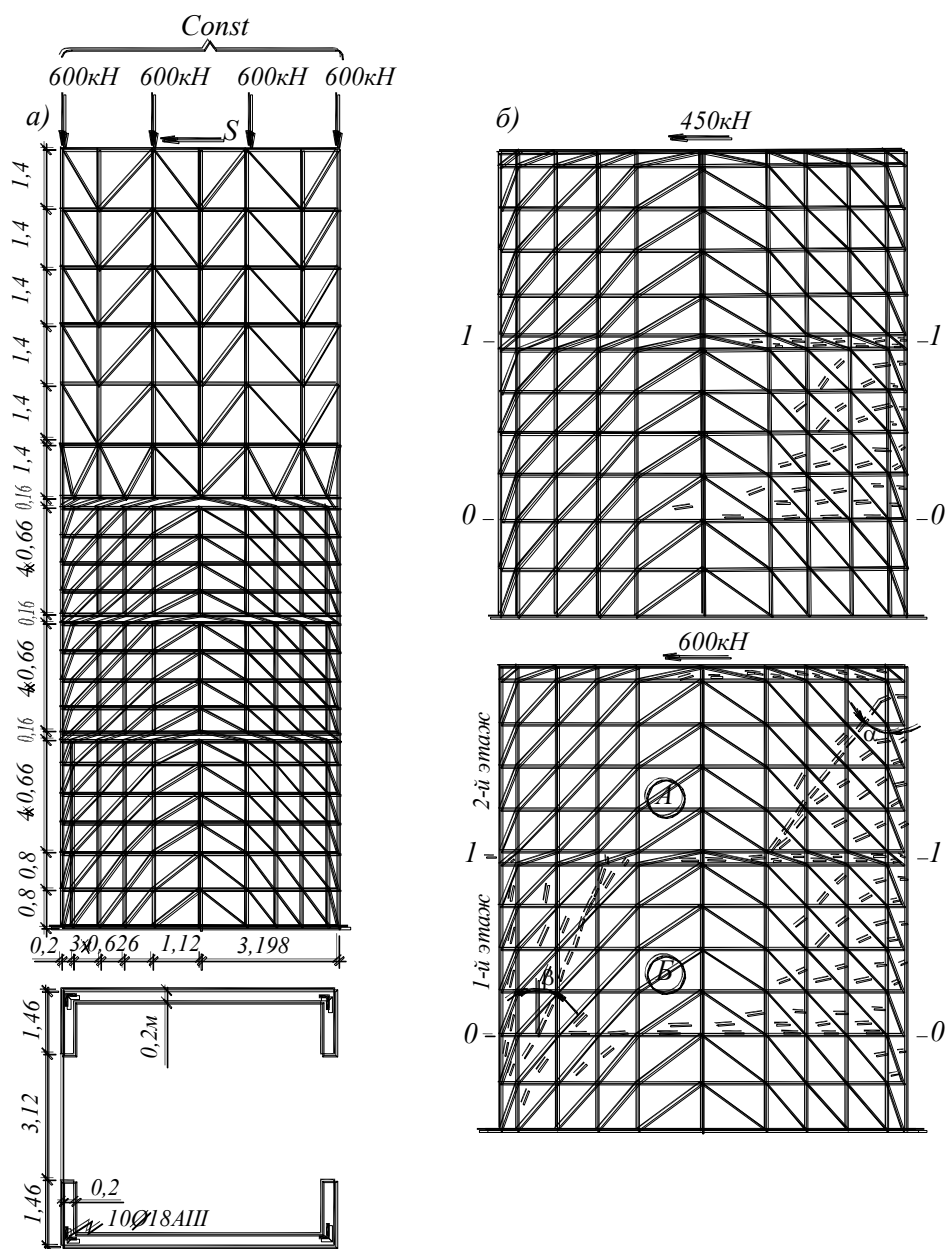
Schema de calcul a peretelui structural al fragmentului cu 6 nivele (a) și traiectoria fisurilor la nivelele inferioare (b).
